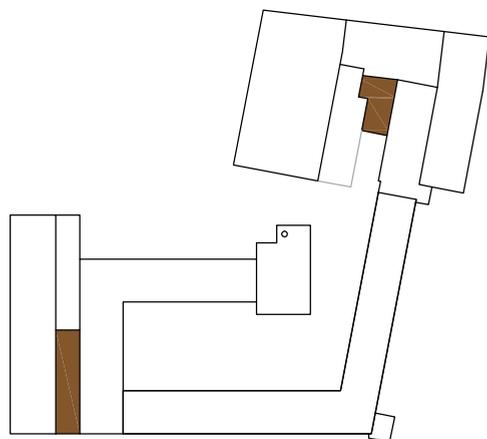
Erdgeschoß-Grundriss zum Zubau des Websaales, 1962
